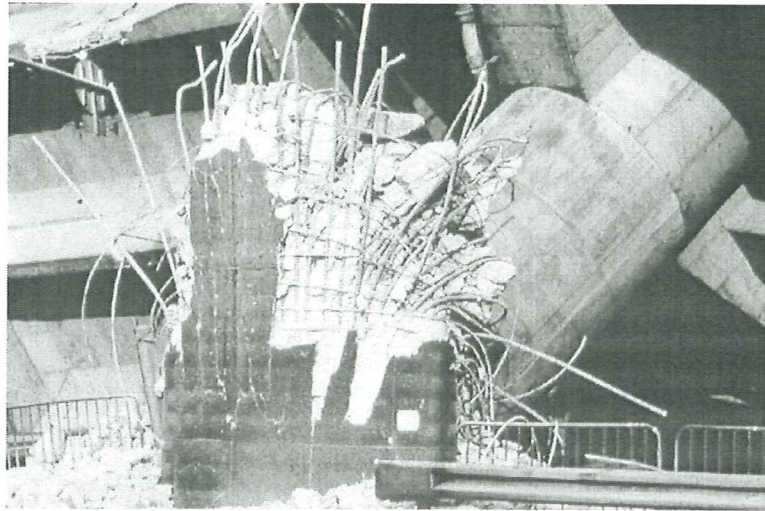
Una pila de un puente pila fue completamente destruida cerca a la superficie del terreno presentando rotura en muchas de sus barras de refuerzo de acero, Higashi - Nada, Kobe, (Architectural Institute of Japan Society of Civil Engineers).
